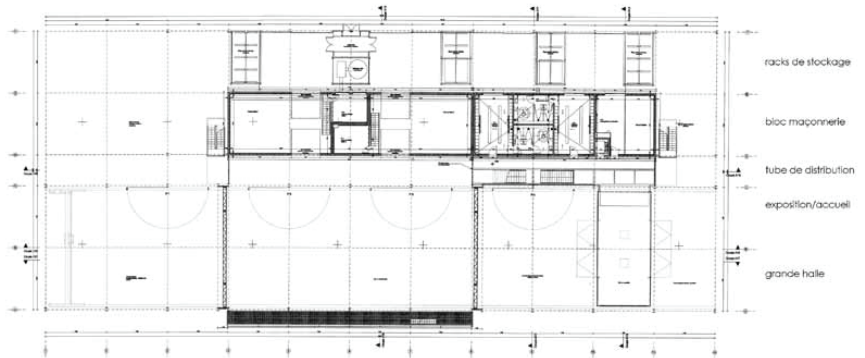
Grundriss der GAIA - Erdgeschoss
